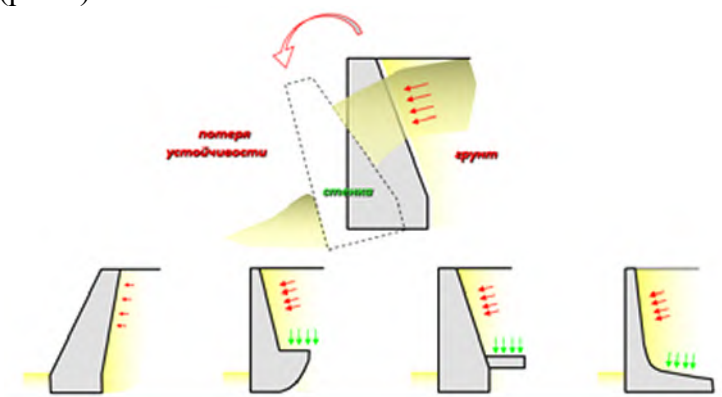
Устойчивость подпорной стенки. Конструктивные решения по вовлечению грунта в устойчивость стенки
